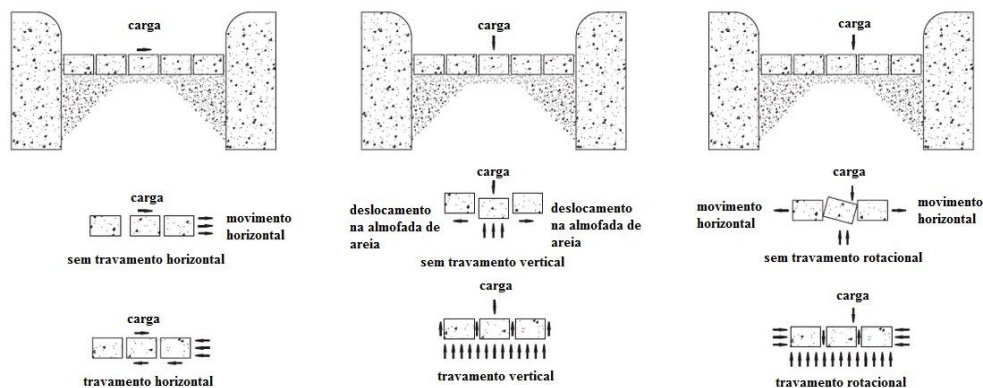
5 - Tipos de travamento em pavimentos de BPB
